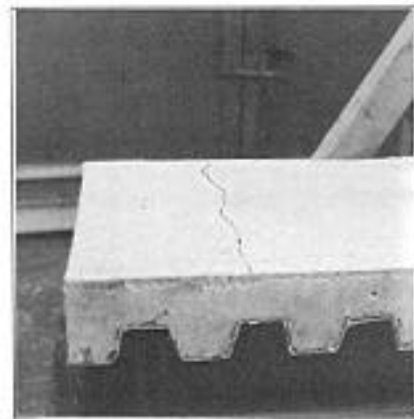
Campione t2 dopo il collasso della trave in acciaio: particolare dell'appoggio
